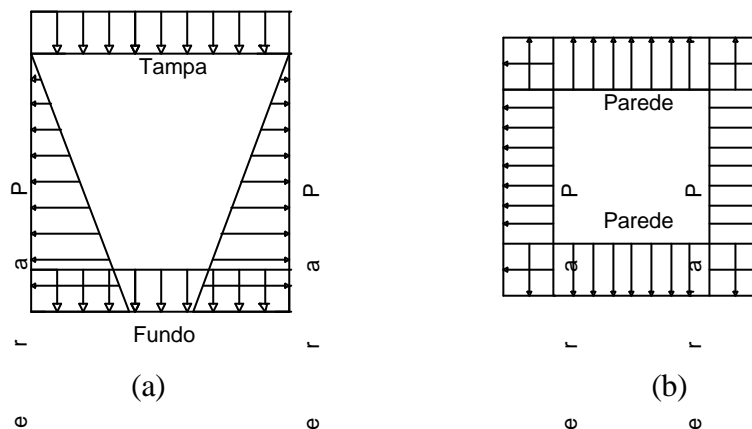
Reservatório elevado cheio: (a) corte vertical; (b) corte horizontal.
